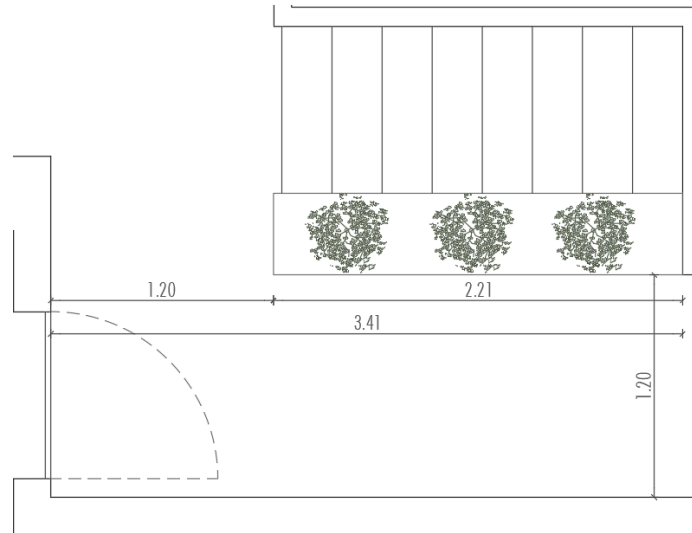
Planta existente do hall de entrada (Fonte: Autora, 2023)
